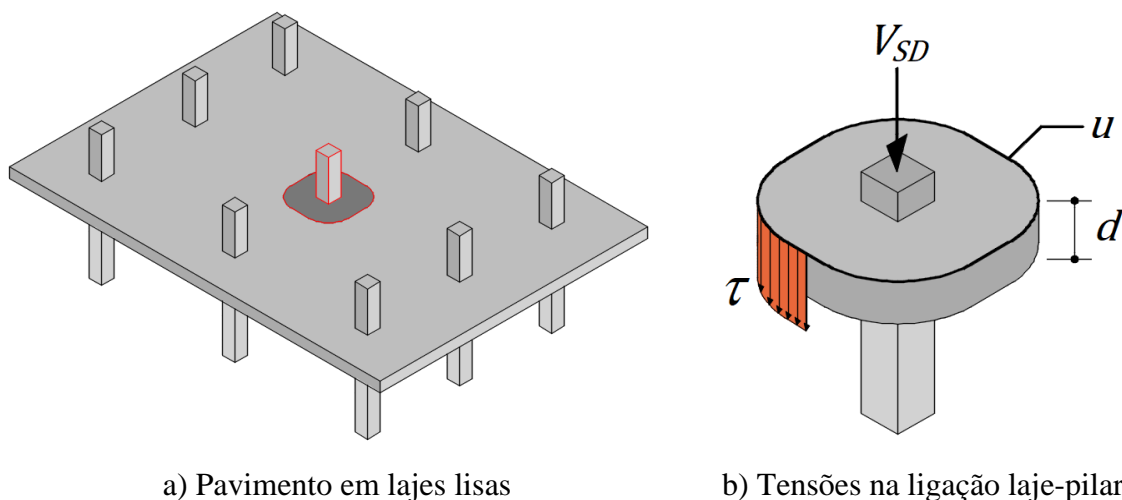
Esquema de esforços em uma ligação laje pilar (Adaptado de Santos, 2018)
